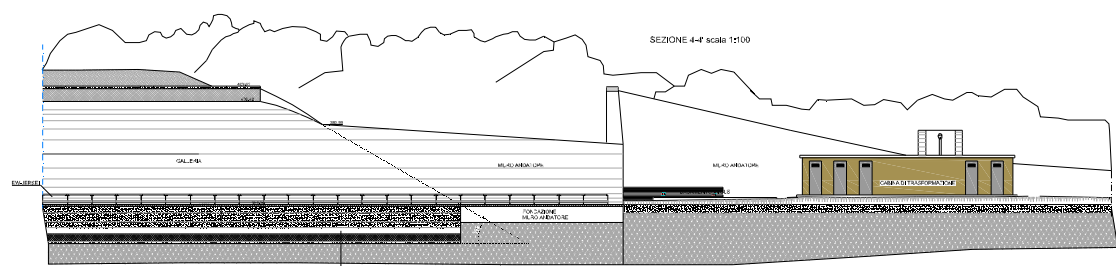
Sezione longitudinale galleria dx - imbocco lato Serino
